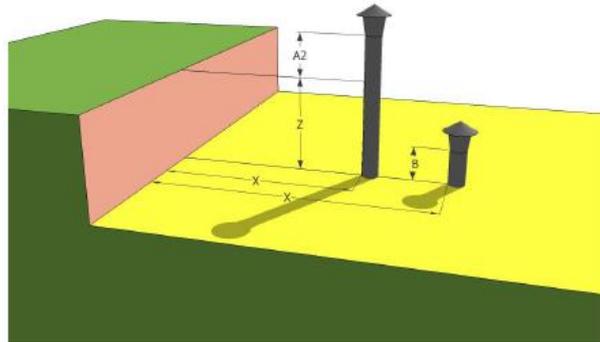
Quote di sbocco in funzione della distanza del terminale dall'ostacolo privo di aperture
